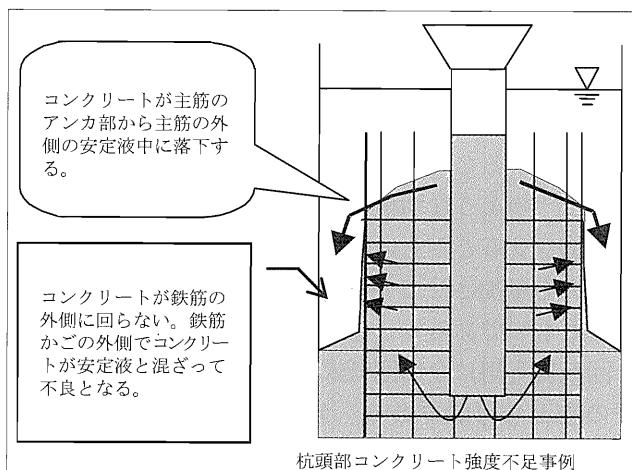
堤所打ちコンクリート棟の施工不良例^[19]
